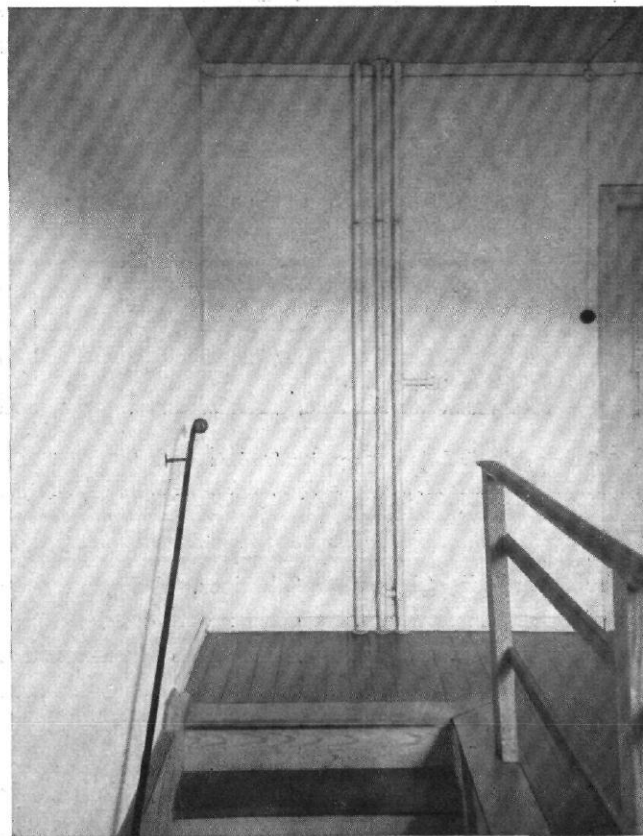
| Haus Dr. F. Wertheimer, Stuttgart | Fabriziertes Fachwerkhaus, Haustyp W | Ausmündung der Hauptgeschosstreppe, Wände und Decken weiß, die Trittstufen in Eichenholz, Fußböden Oregon, Treppengeländer ungestrichenes Kiefernholz, eiserner Handlauf rot ge-
